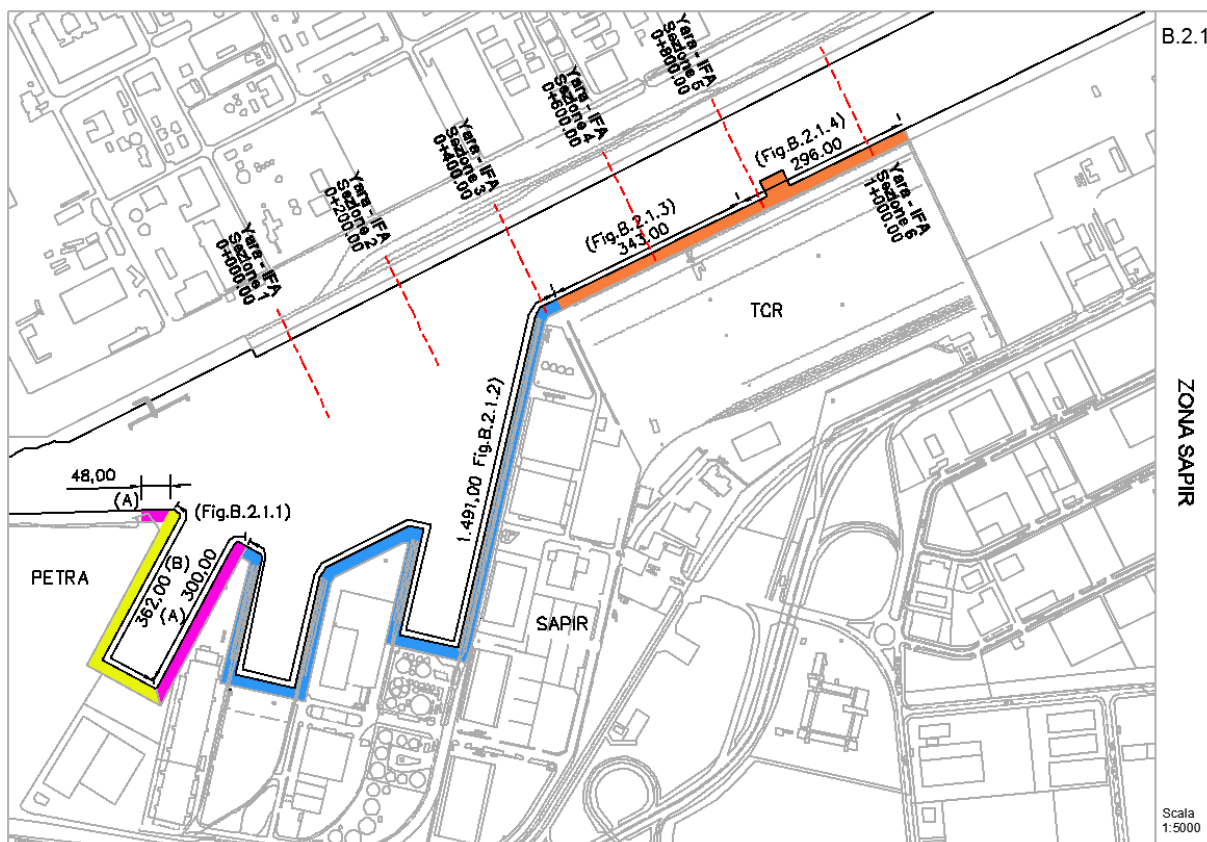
Stralcio planimetrico del Canale Candiano con l'indicazione delle sezioni e delle banchine in destra considerate nel tratto YARA – IFA
